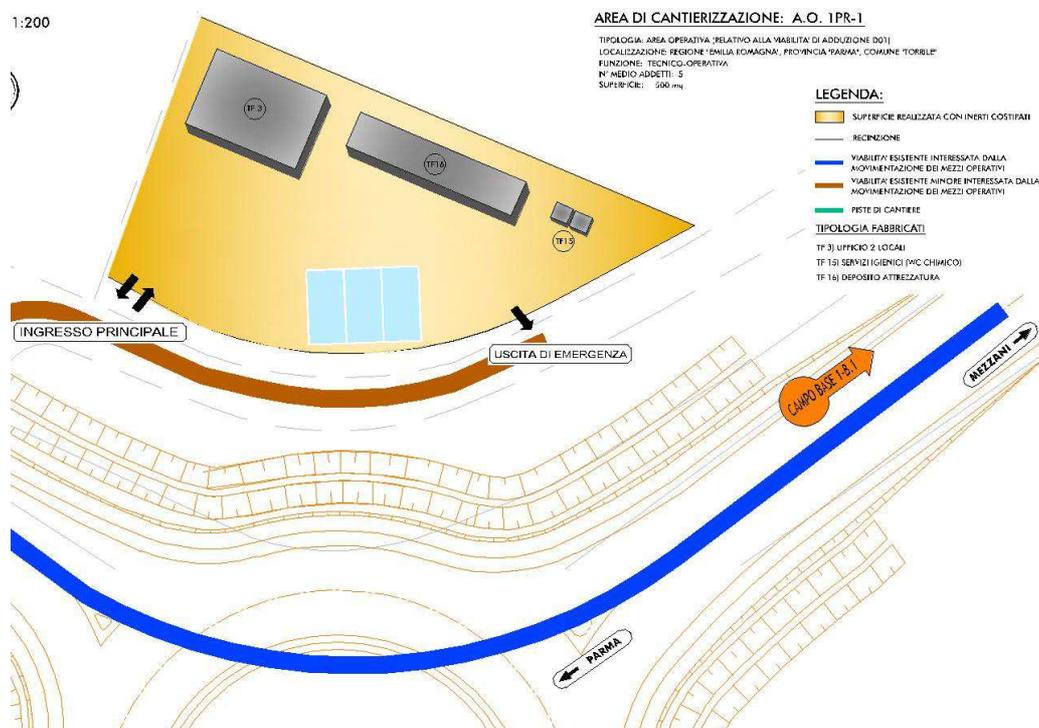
LAYOUT AREA DI CANTIERE OPERATIVA
